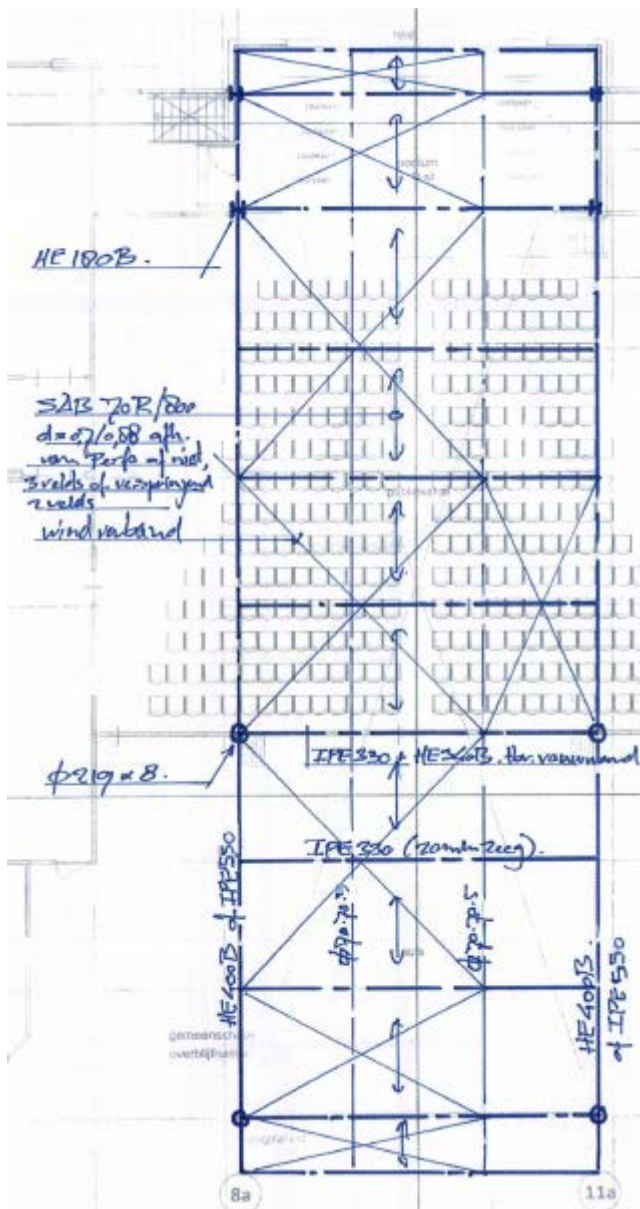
/ Constructieoverzicht uitbreiding Triops d.d. 27-04-2014.
